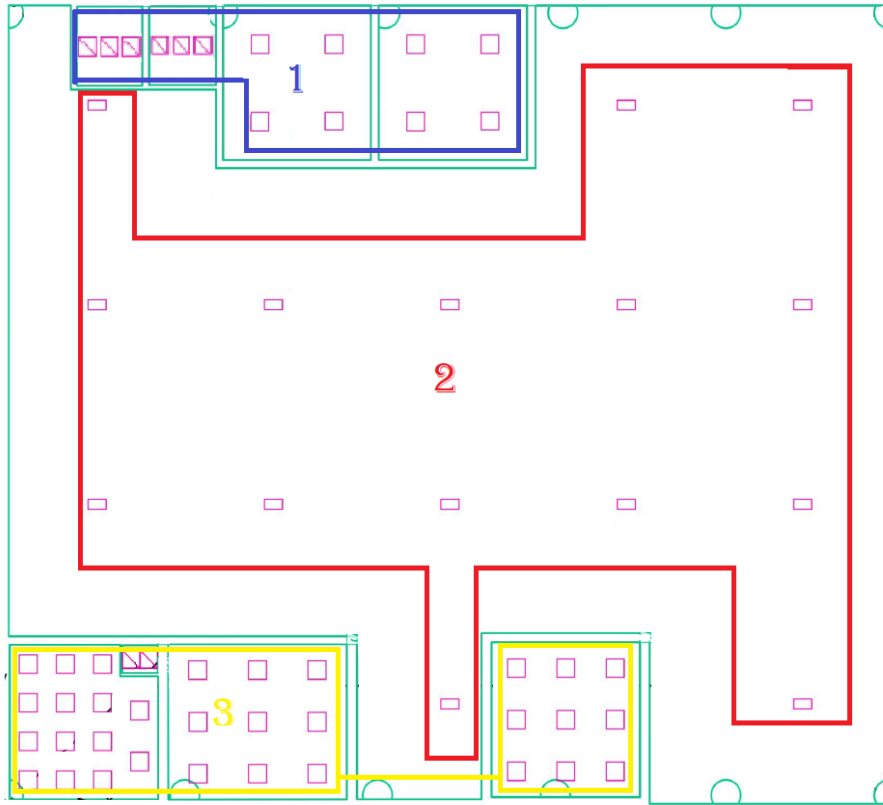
Sectorización en subdivisiones de la planta. Fuente: Autores.
